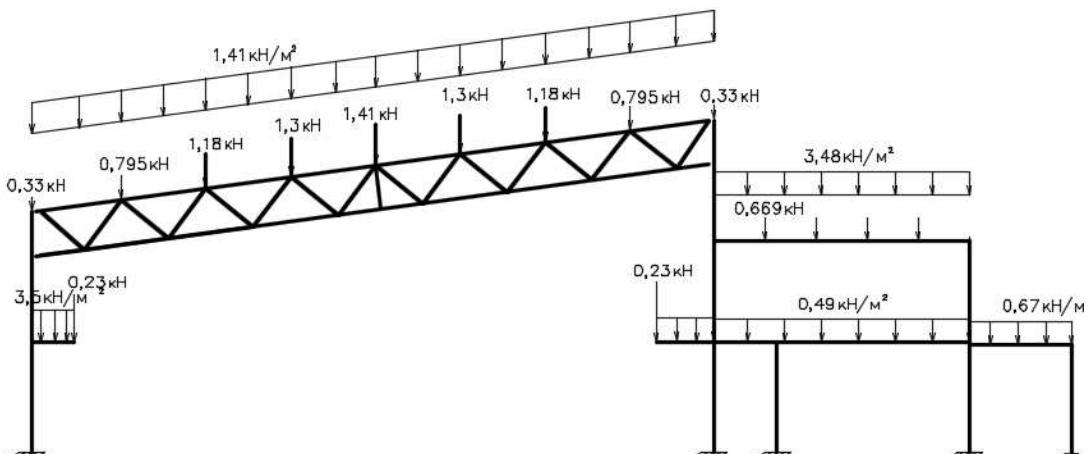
Расчетная схема для определения усилий от постоянных нагрузок
